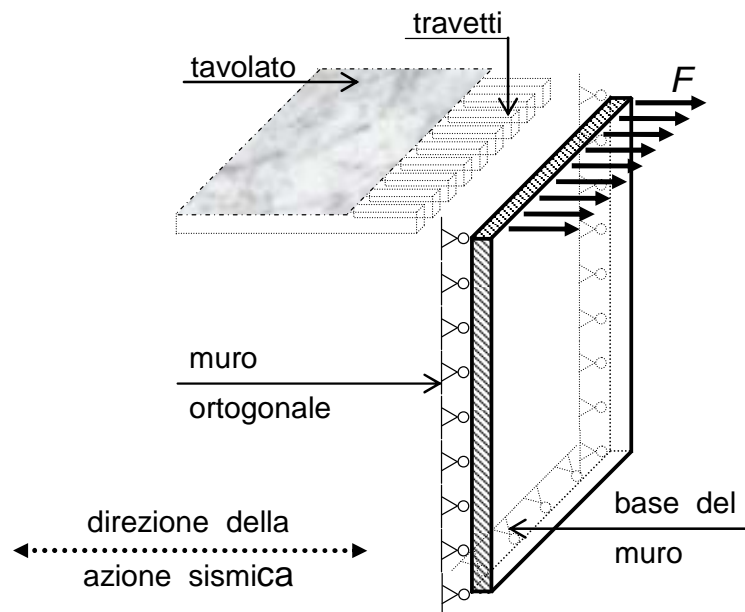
c/1°. La forza sismica di piano G comporta l'insieme di forze orizzontali, F , scaricate sulla sommità del muro dalla testa dei travetti. Le forze F sono ortogonali al muro porta-travetti. Il muro porta-travetti è controventato, in verticale dai muri ortogonali, e in orizzontale — a seconda — dalla fondazione, oppure dall'impalcato inferiore. Il muro porta-travetti è quindi vincolato su tre lati ed è assoggettato a forze (assimilabili a un carico uniformemente distribuito) dirette ortogonalmente al muro stesso e applicate sul contorno libero.
